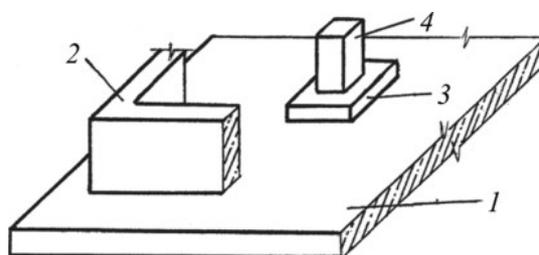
Размещение стен и колонн на плитном фундаменте: 1- сплошная плита, 2 стена, 3 – уширение под колонну, 4 – колонна
